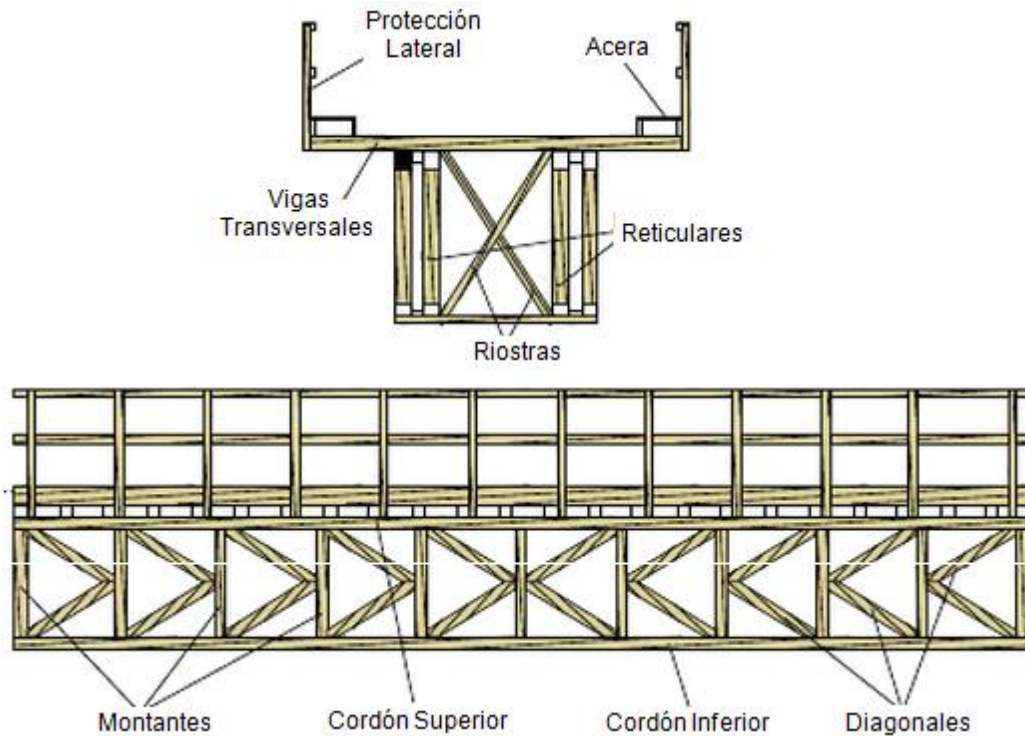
Secciones transversales con vigas en celosía tipo K [14]
